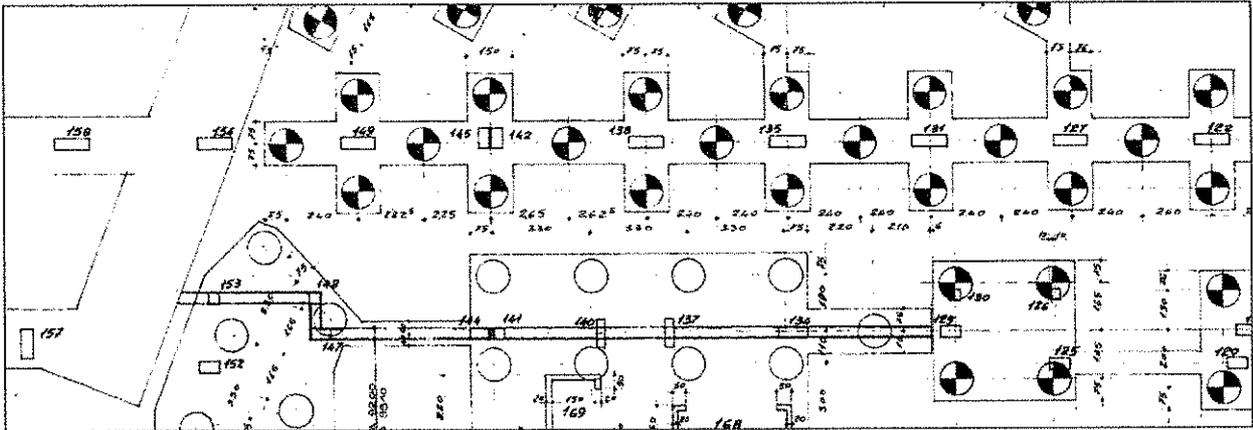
Progetto originario – Tav. 6 – Stralcio - Particolare fondazioni pilastri della spina centrale
